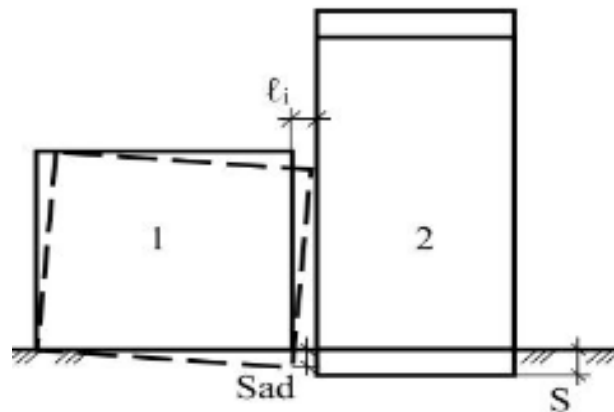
Визначення ширини осадового шва між будівлями: 1 – будівля ранньої споруди; 2 – нова будівля
